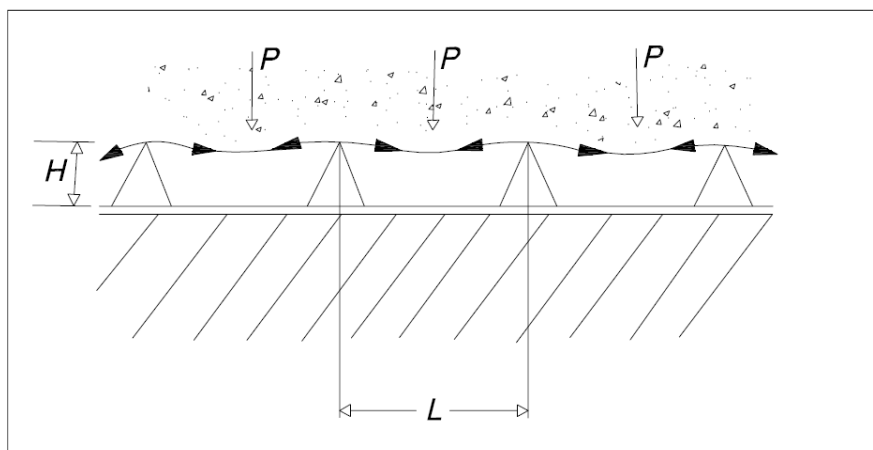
Diminuzione dell'area della sezione trasversale del geocomposito drenante a contatto con il terreno
